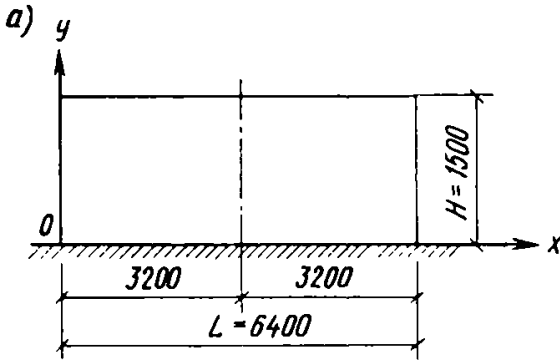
Расчетная схема жилого дома с поперечными несущими стенами при расчете как горизонтального составного стержня
